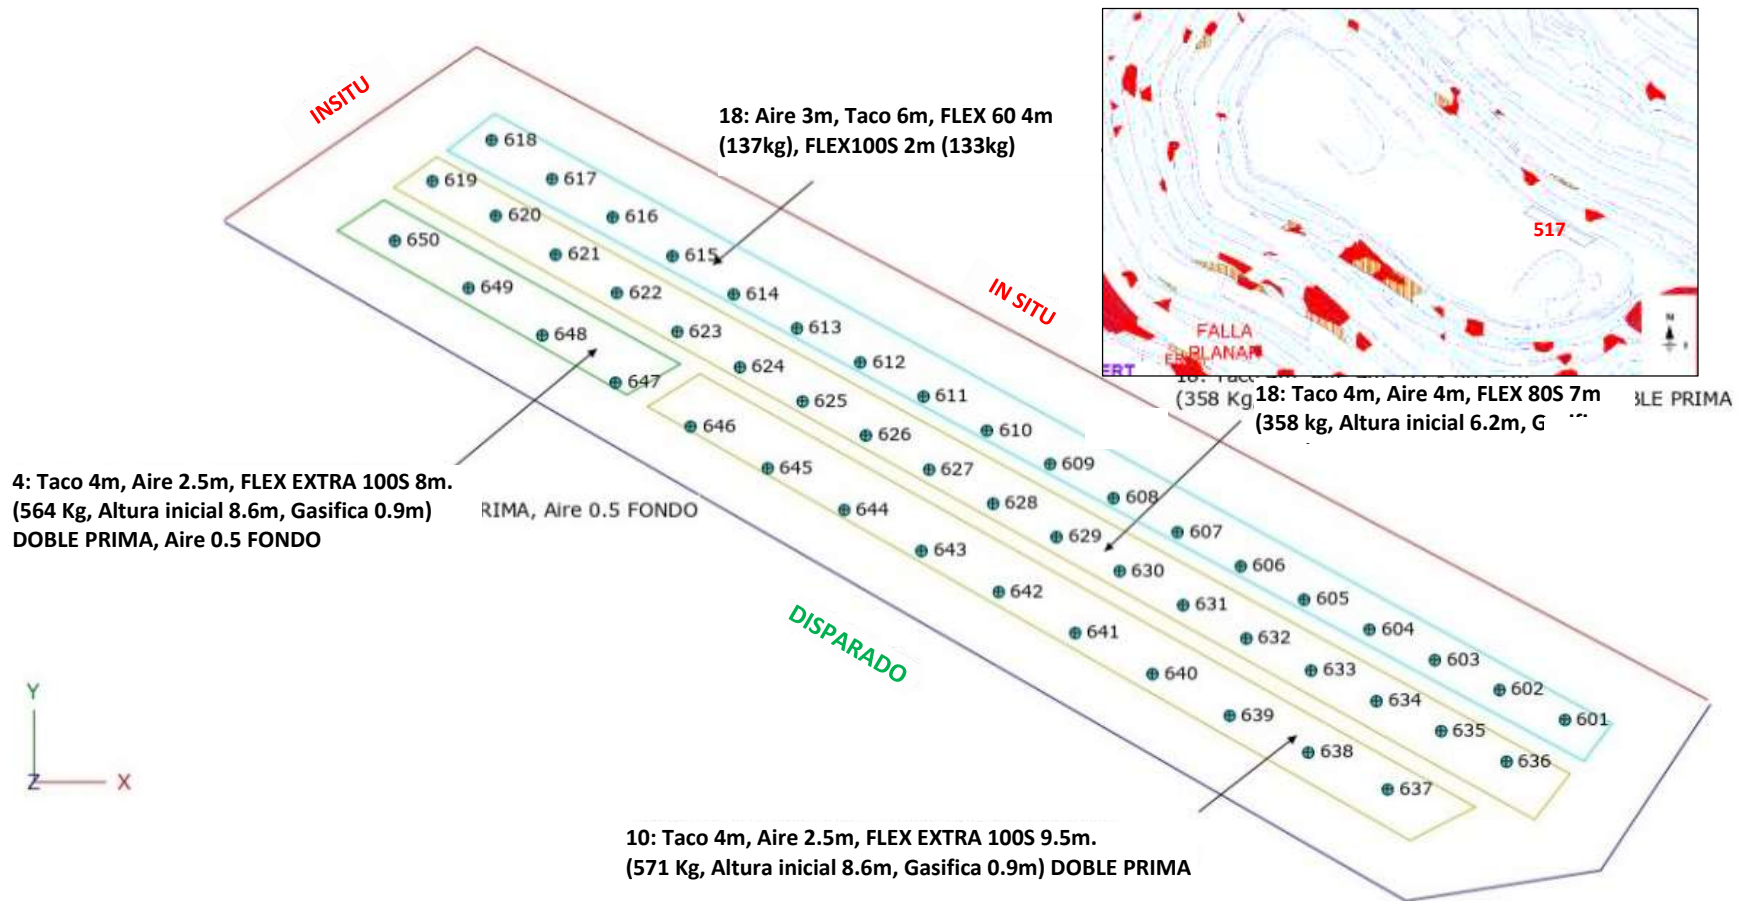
Plano de detalles y ubicación SR 2363-0517.
